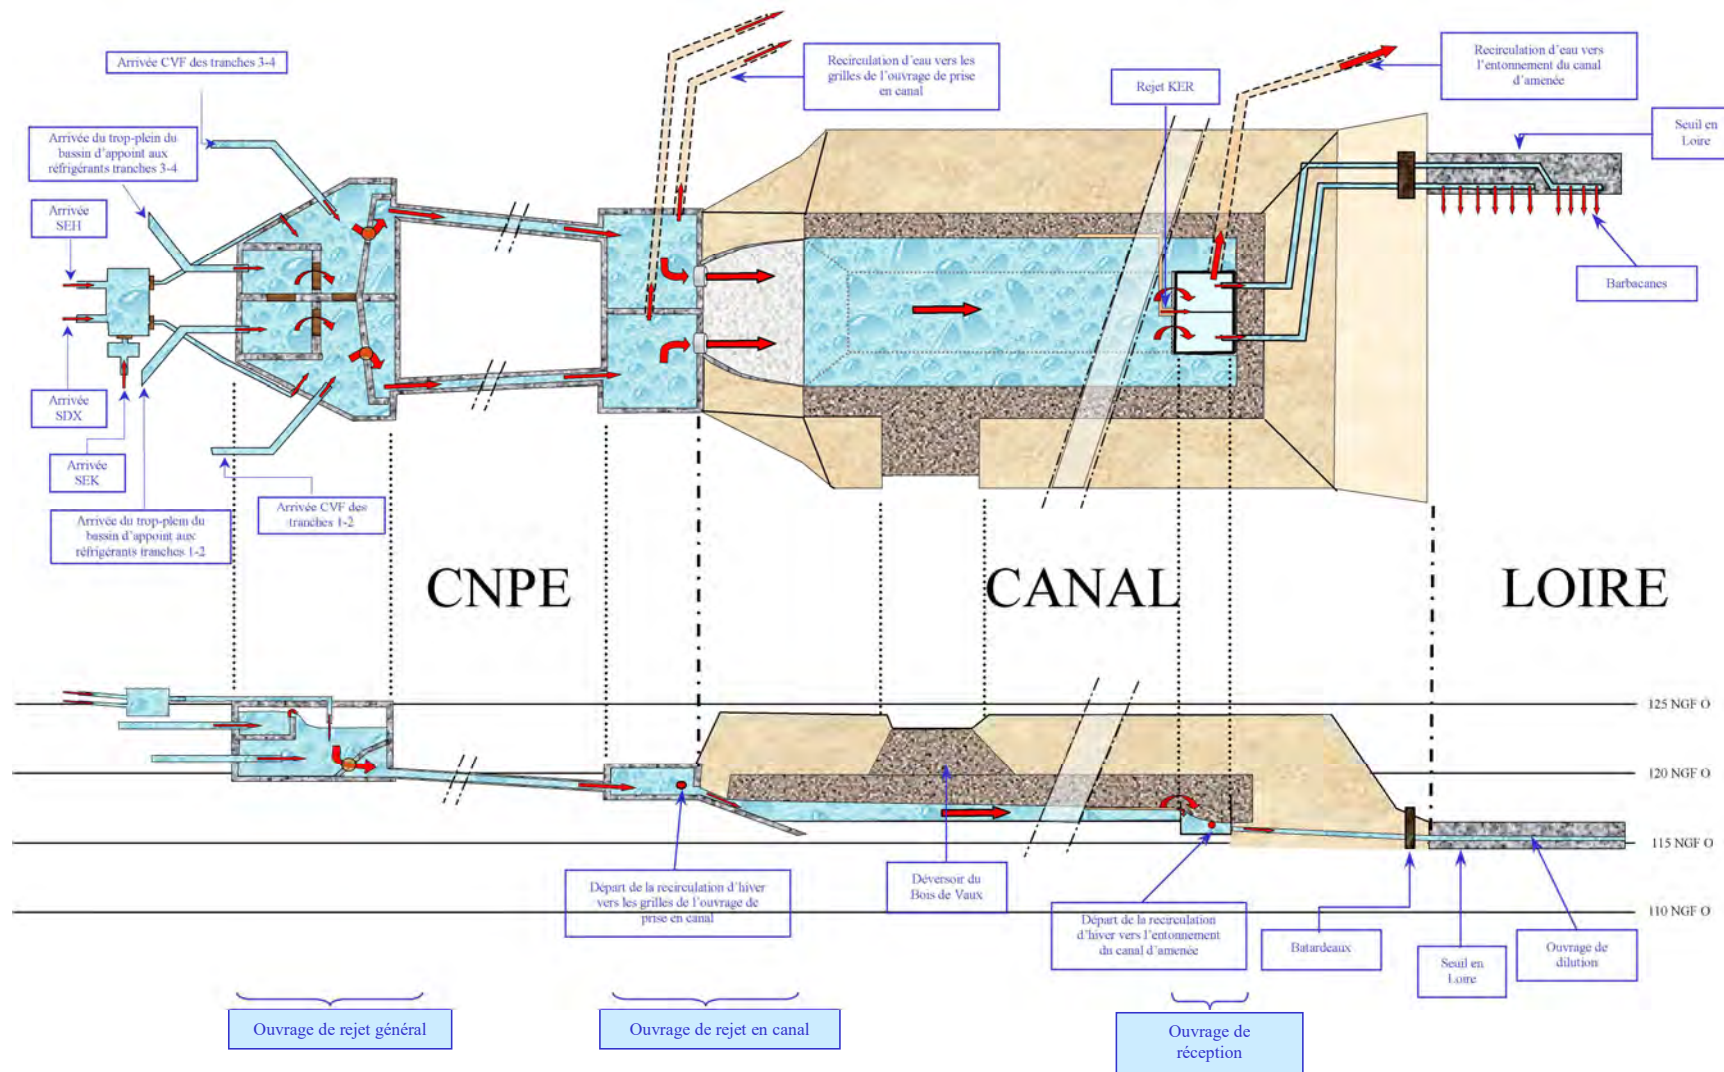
Vue en coupe et en plan des ouvrages de rejet
